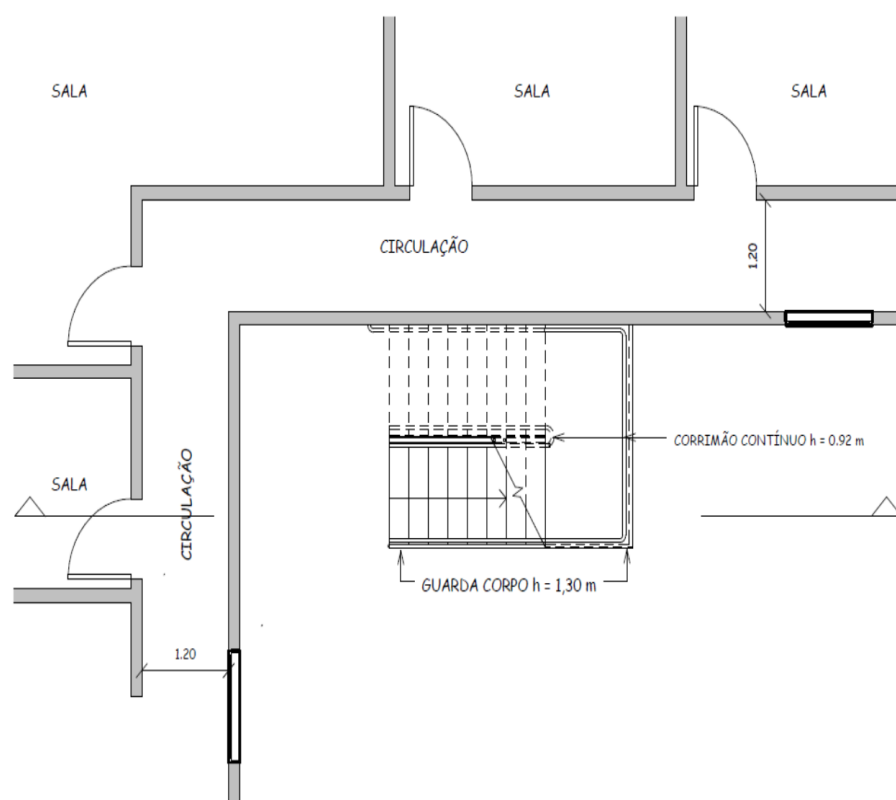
A - Escada aberta externa - térreo (planta baixa).
